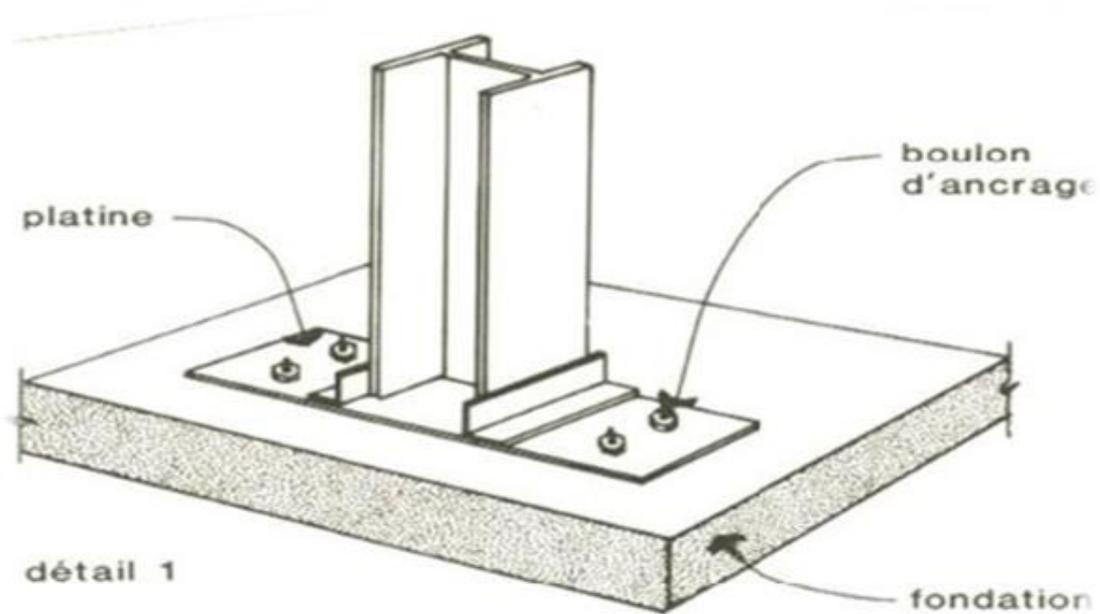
Représentation d'un assemblage poteau métallique et semelle
